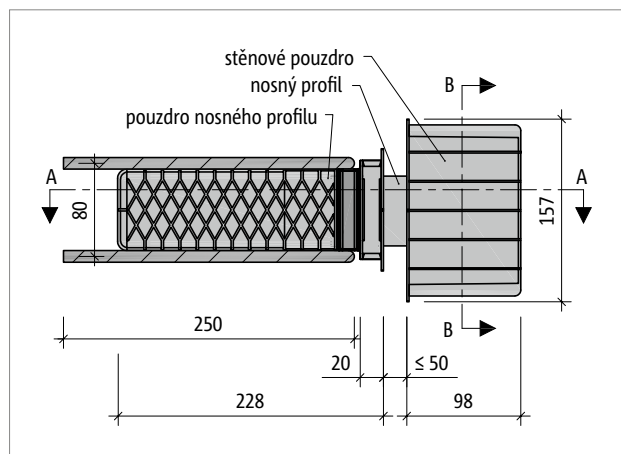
Schöck Tronsole® typ Q: Uspořádání prvků – detail B
